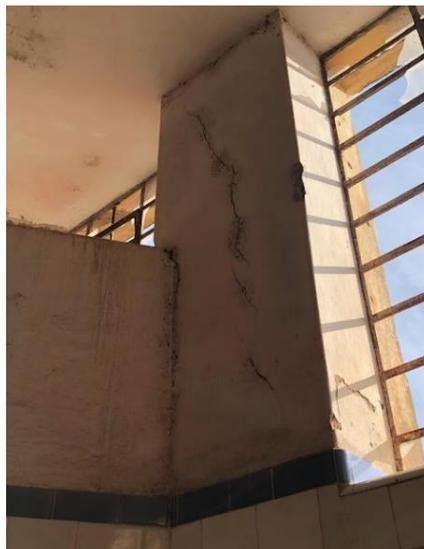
Fissuras mapeadas em revestimento.
